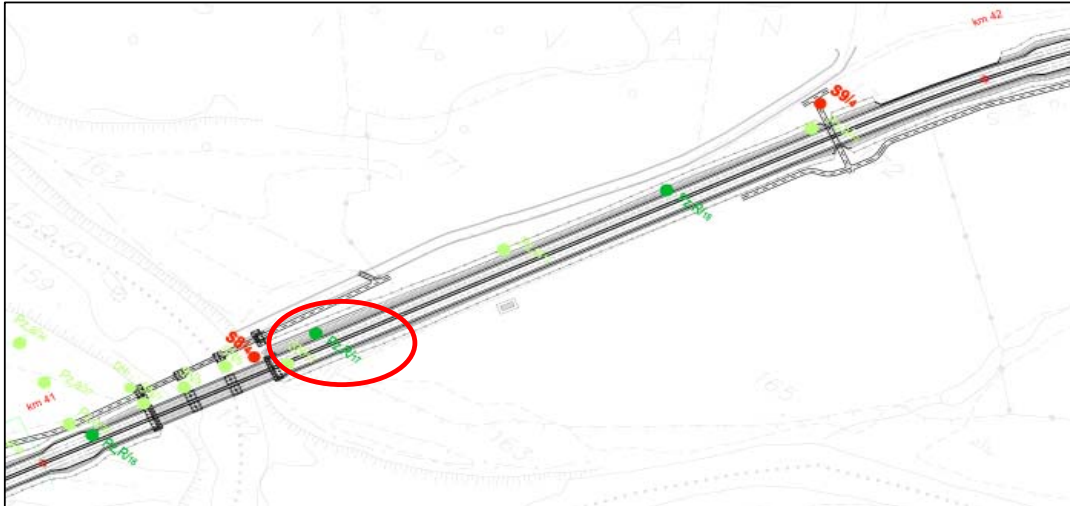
FOTO SATELLITARE CON PROIEZIONE DEL POZZETTO PZR17
